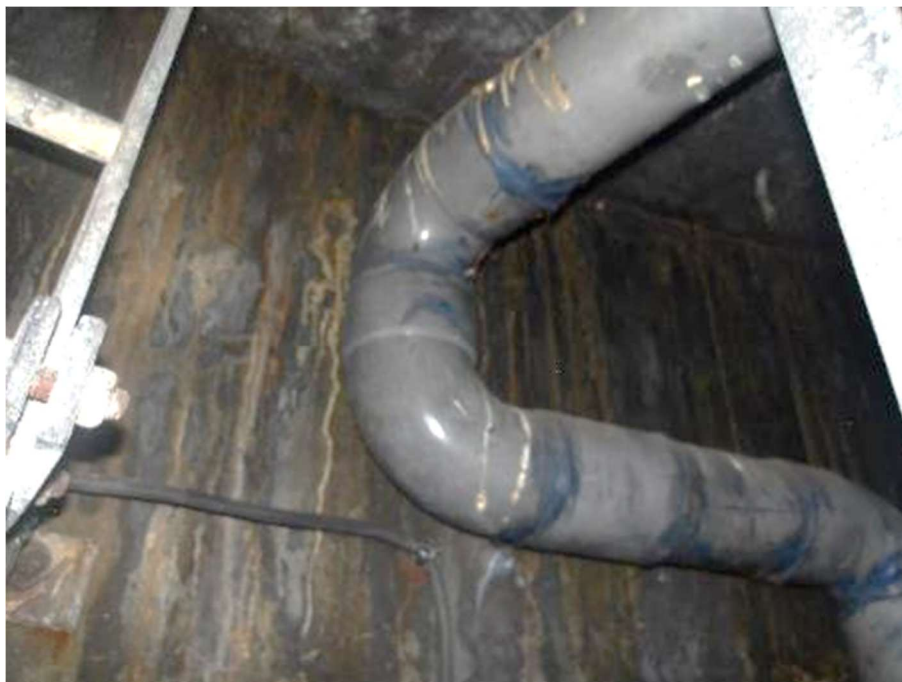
Tuyauterie d'évacuation des eaux pluviales en bon état.
